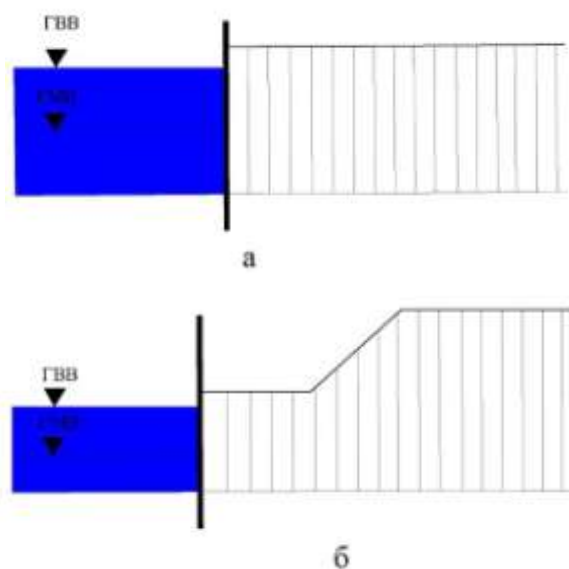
Типы набережных: а – одноярусная набережная с подпорной стенкой, б – двухъярусная набережная (с откосом и подпорной стенкой)
